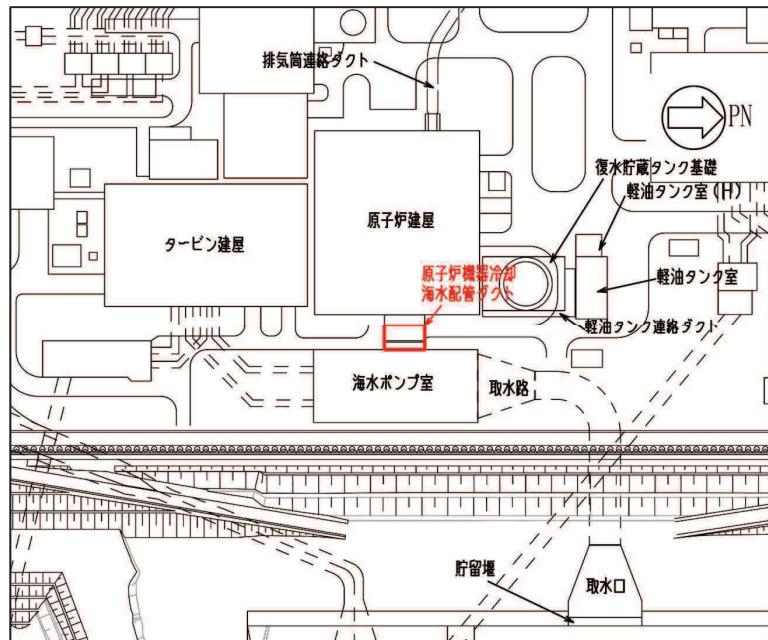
原子炉機器冷却海水配管ダクト配置図
